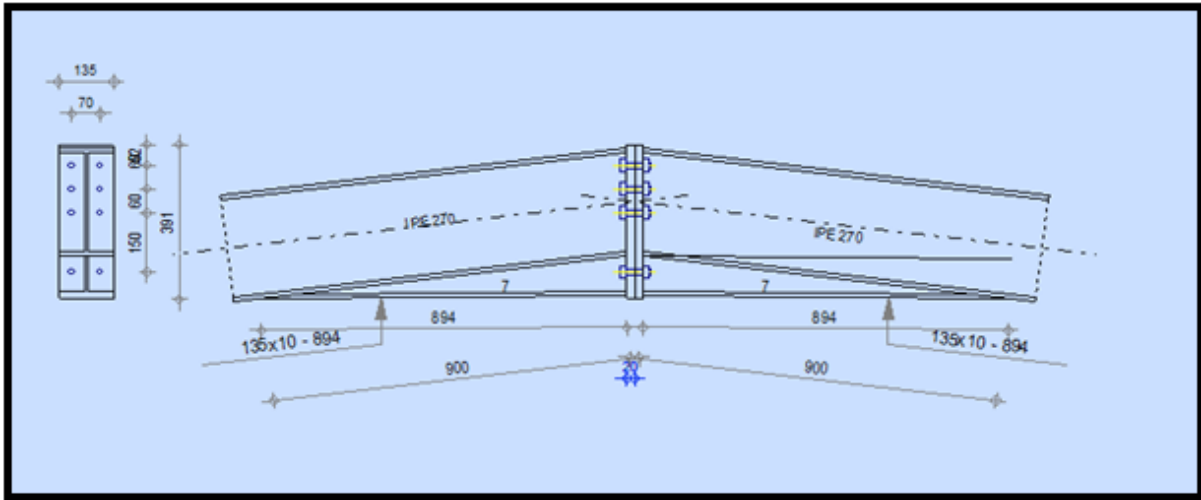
Vu en plan de l'assemblage traverse-traverse
